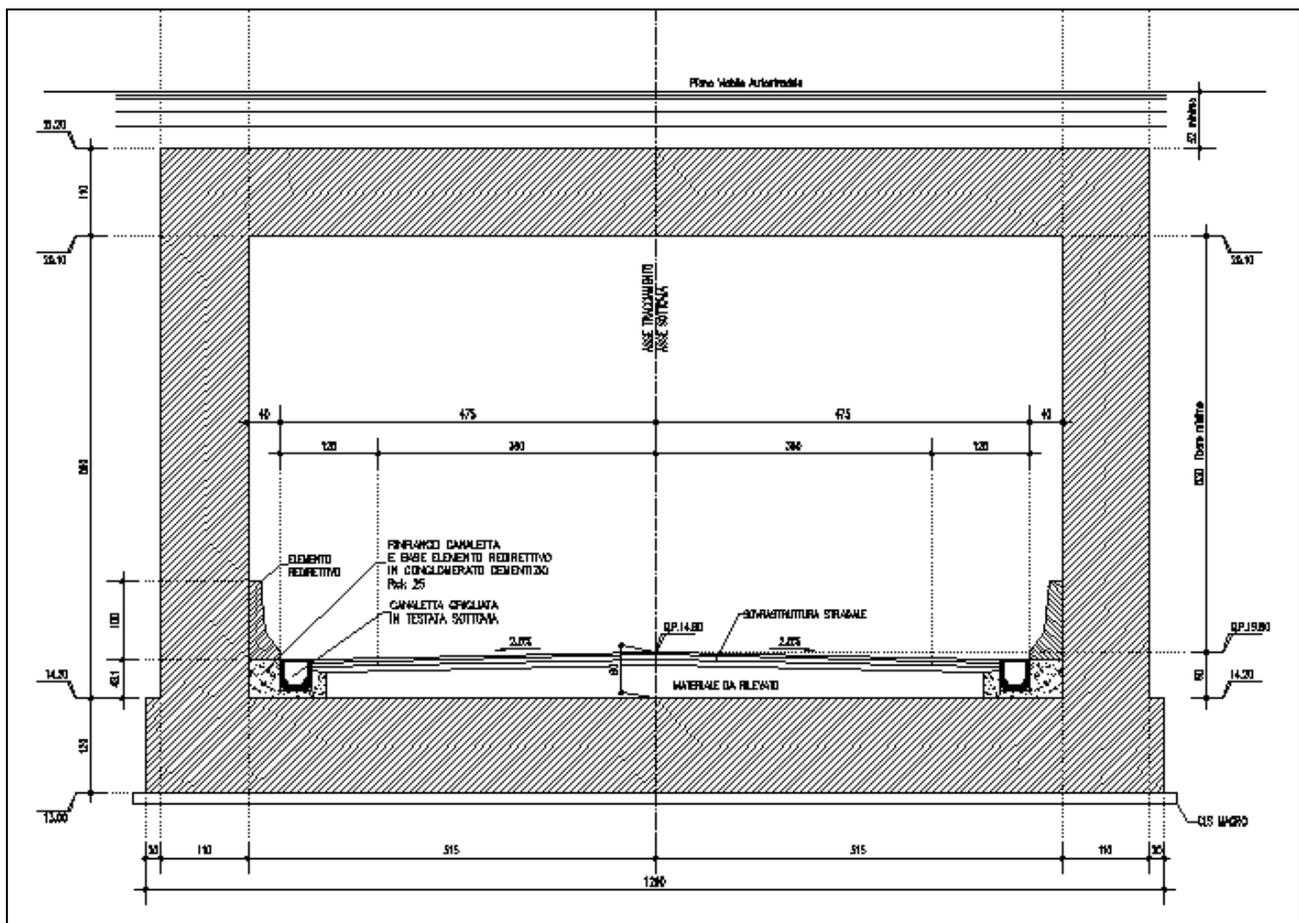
SEZIONE TRASVERSALE DEL SOTTOVIA
